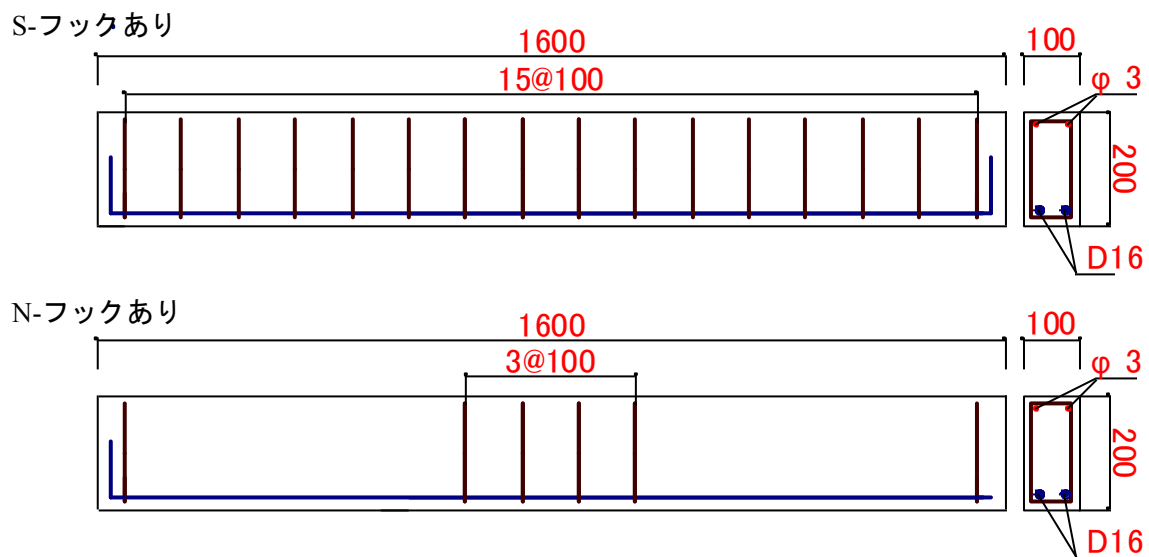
1600 mm供試体概要図一覧 (単位:mm, 有効高さ 177.5 mm)
